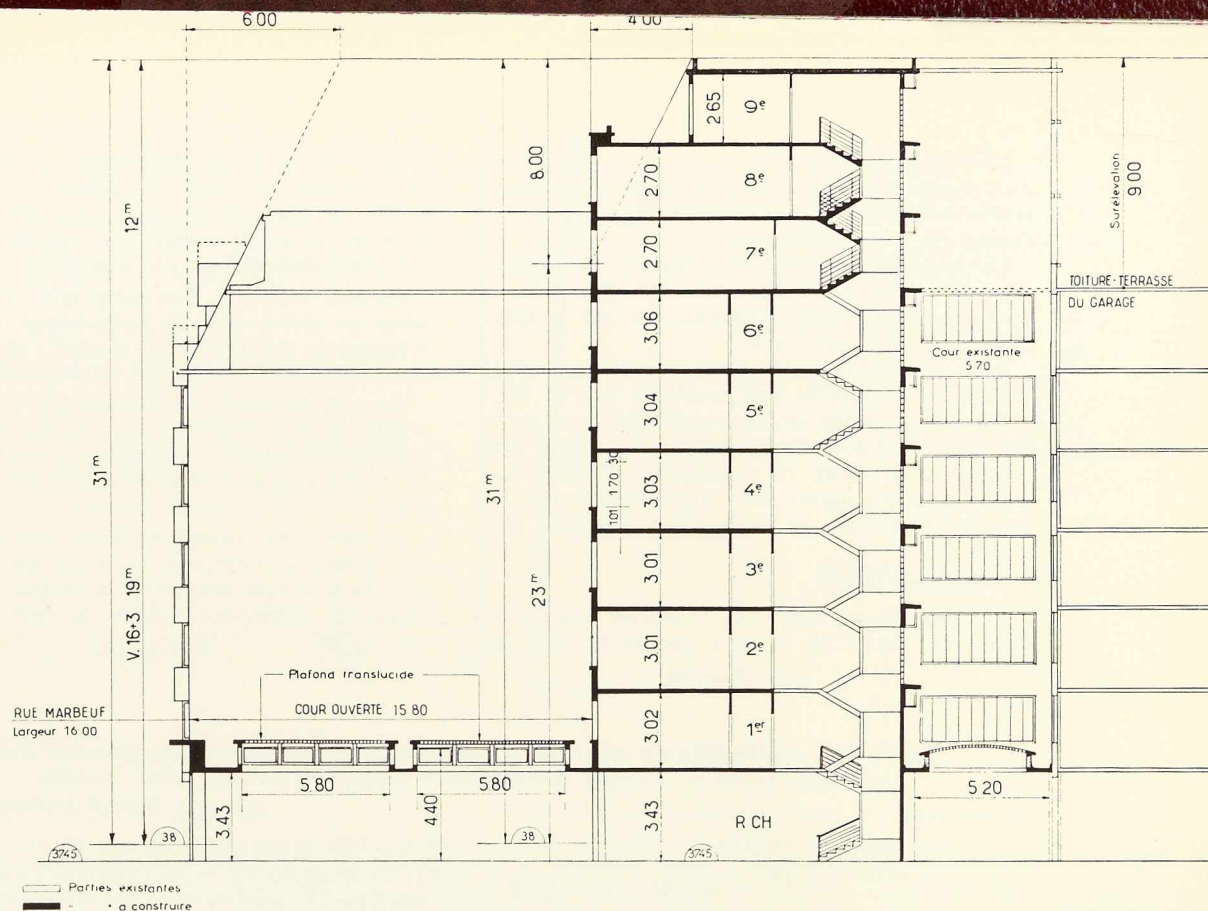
Coupe transversale de l'immeuble sur l'escalier.
